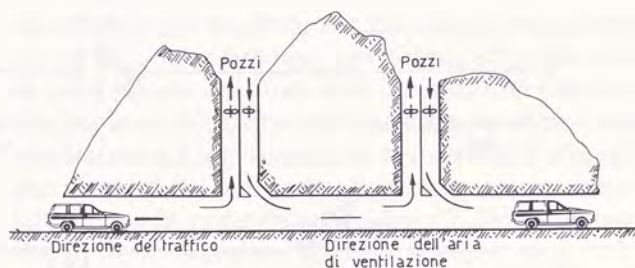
Ventilazione longitudinale con pozzi intermedi
